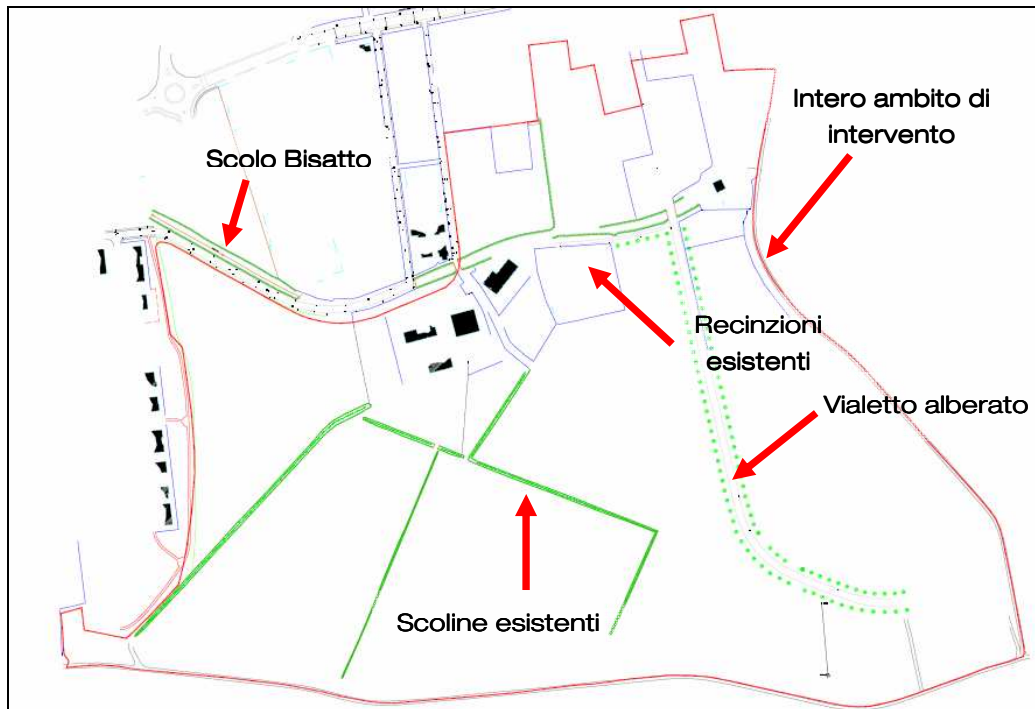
Planimetria della zona di intervento allo stato di fatto.
